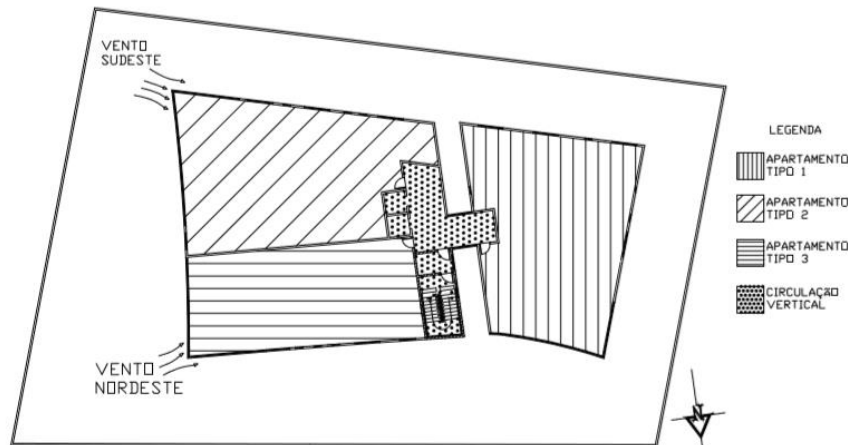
Planta baixa da lâmina. Fonte: elaborado pelos autores.
